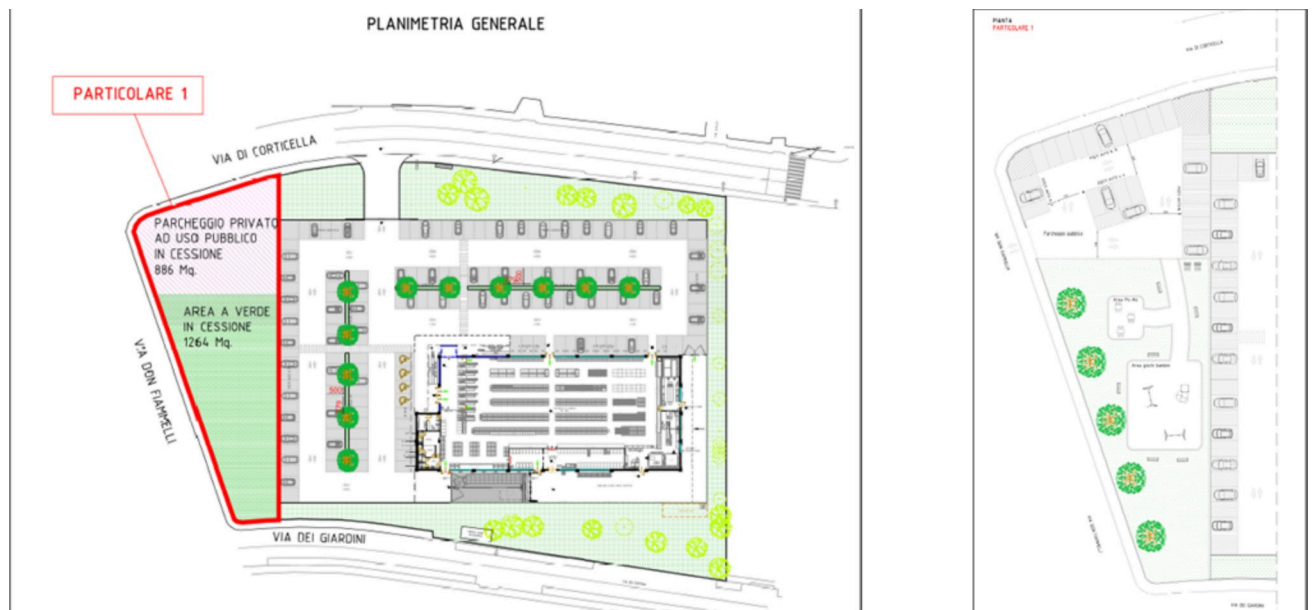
Planimetria intervento edilizio via Don Fiammelli
